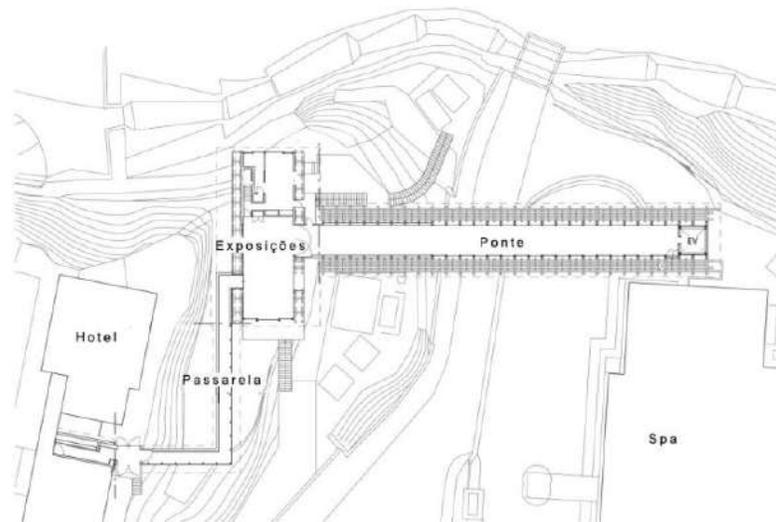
Planta baixa do piso do Spa. (fonte: KKAA)
